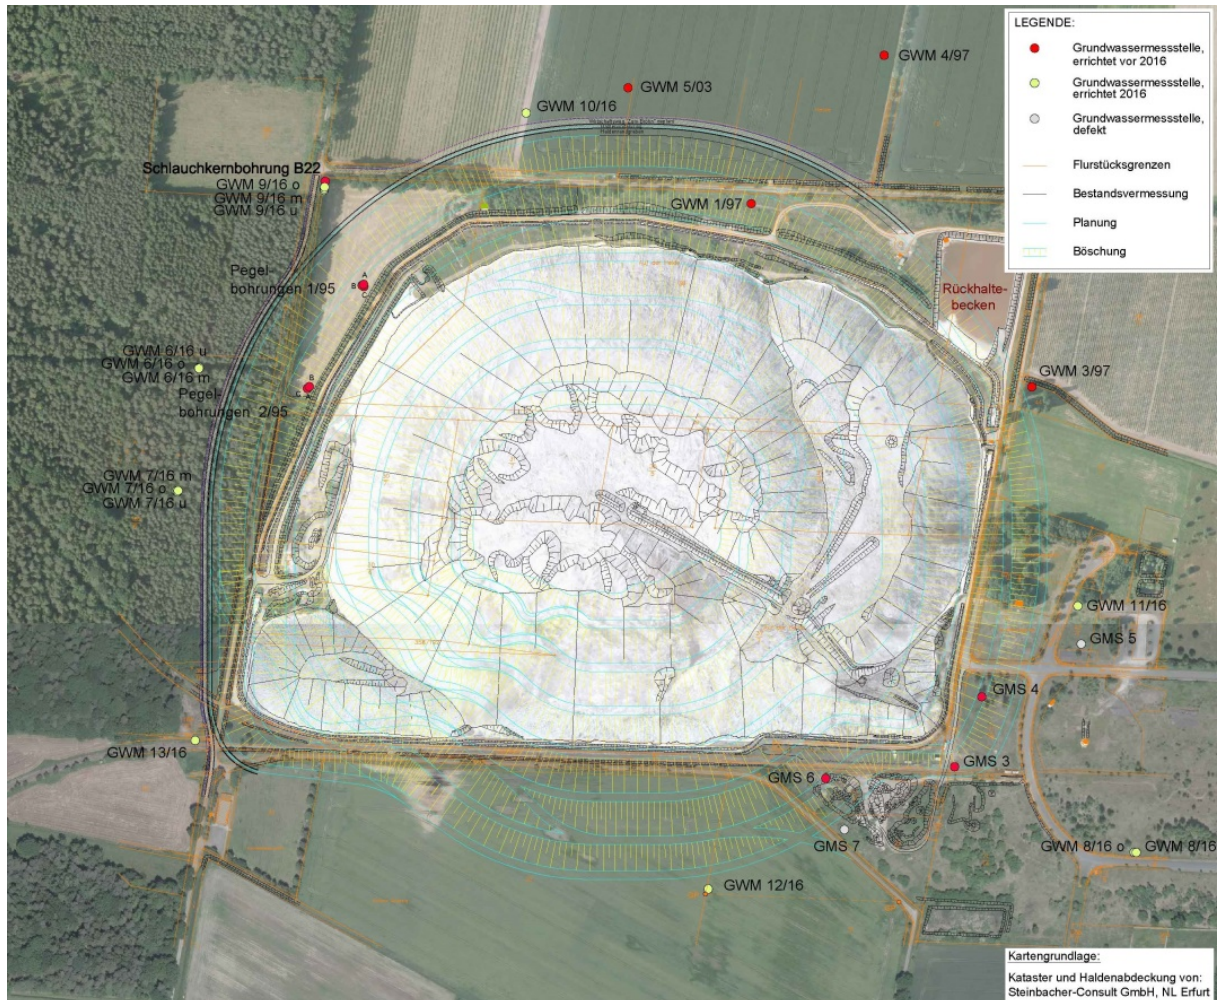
Lageplan Grundwassermessstellen (K+S 2016)
